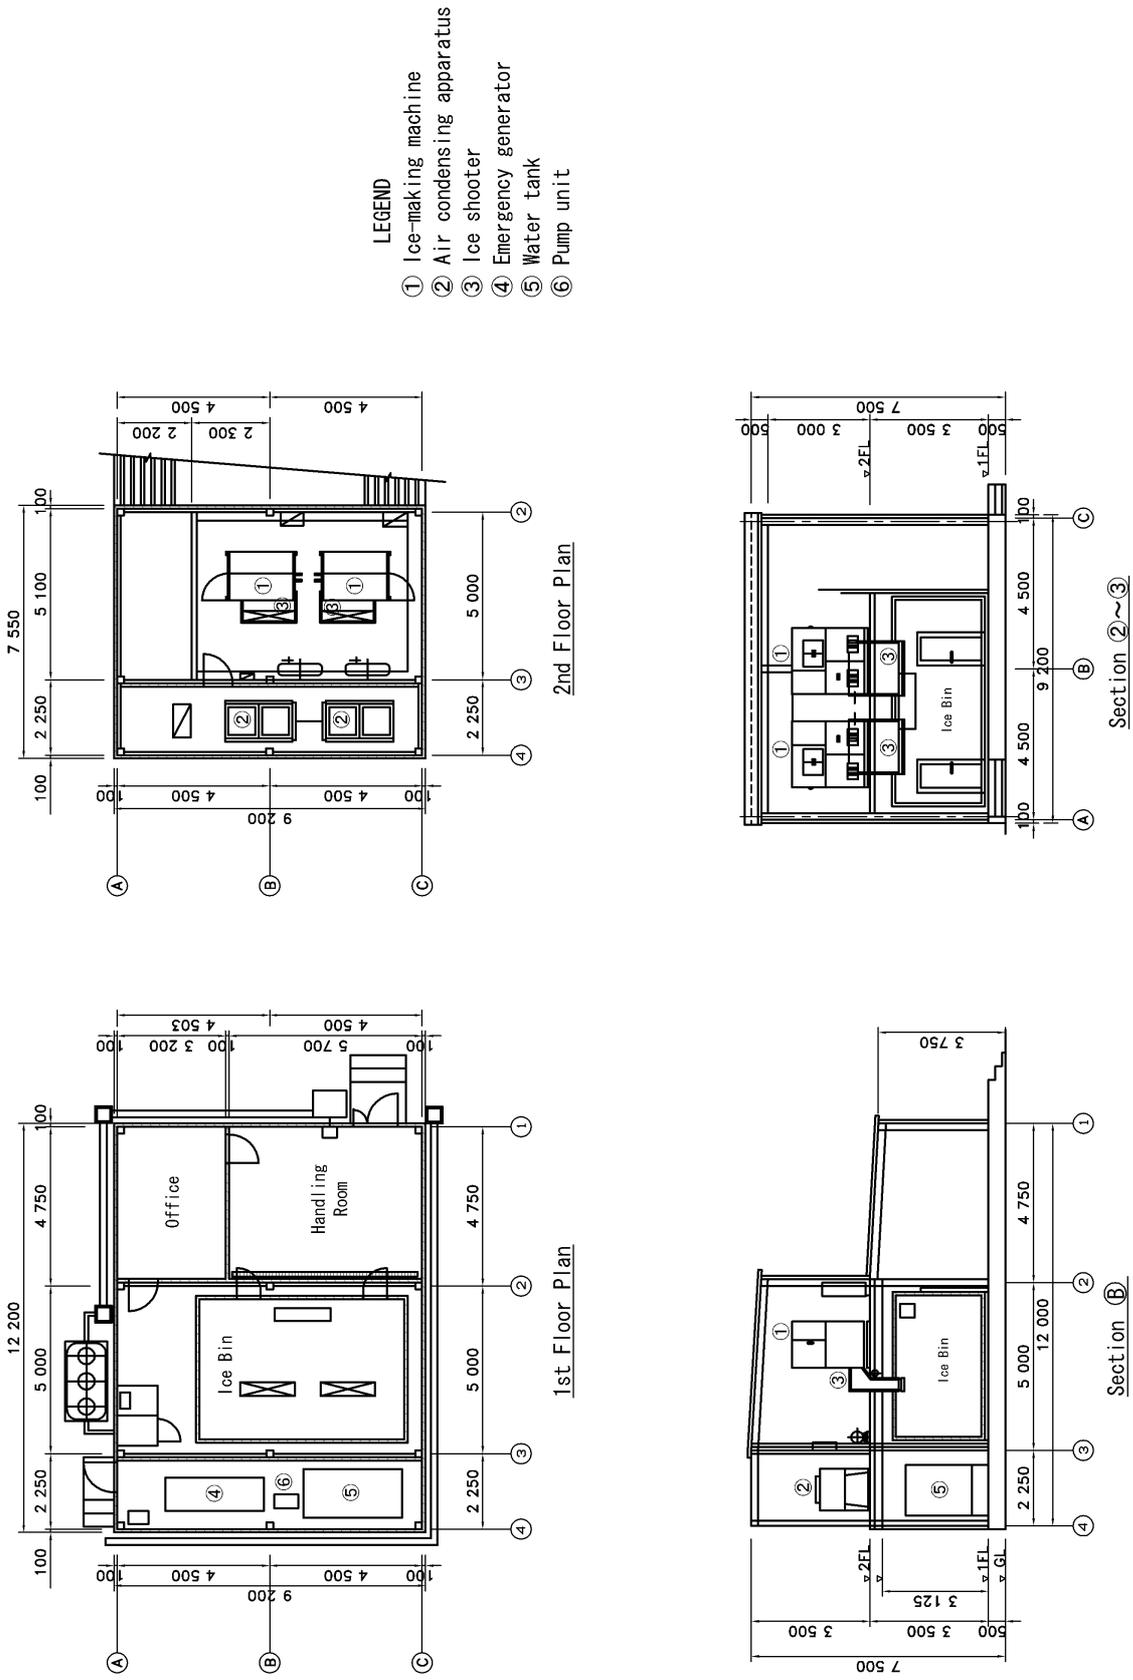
Diseño Estructural de Planta de Hielo
